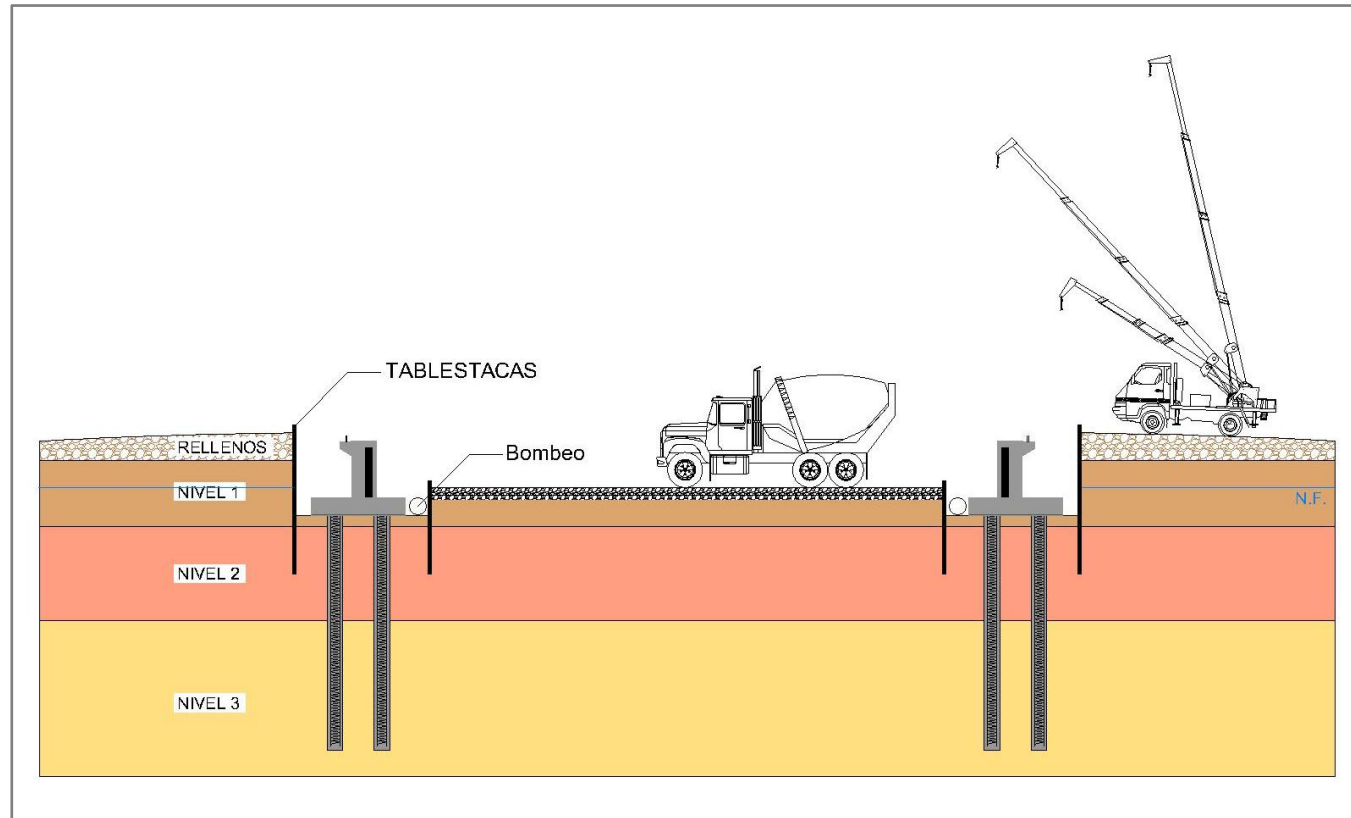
Encofrado, armado y hormigonado de los muros del estribo y del cajero.
